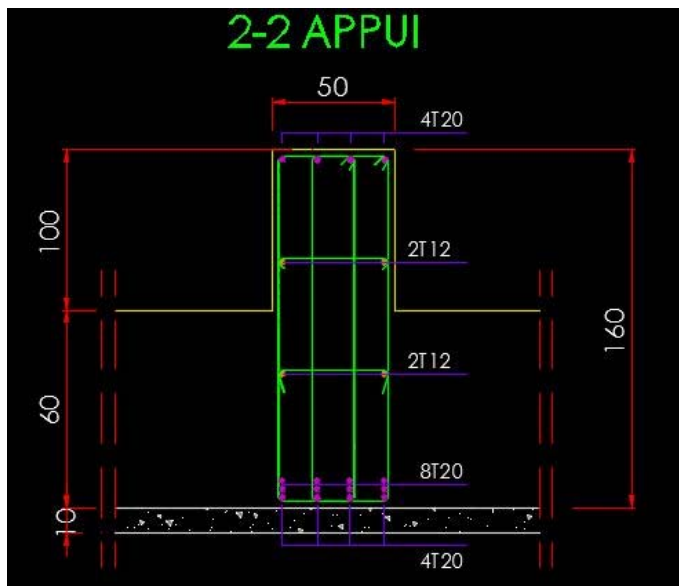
Coupe De Ferrailage De Libage (appui)
